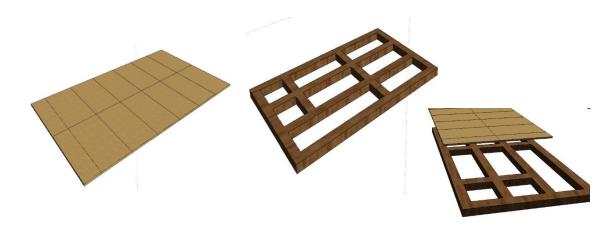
Figura 3D de secuencia de montaje losa de piso.
